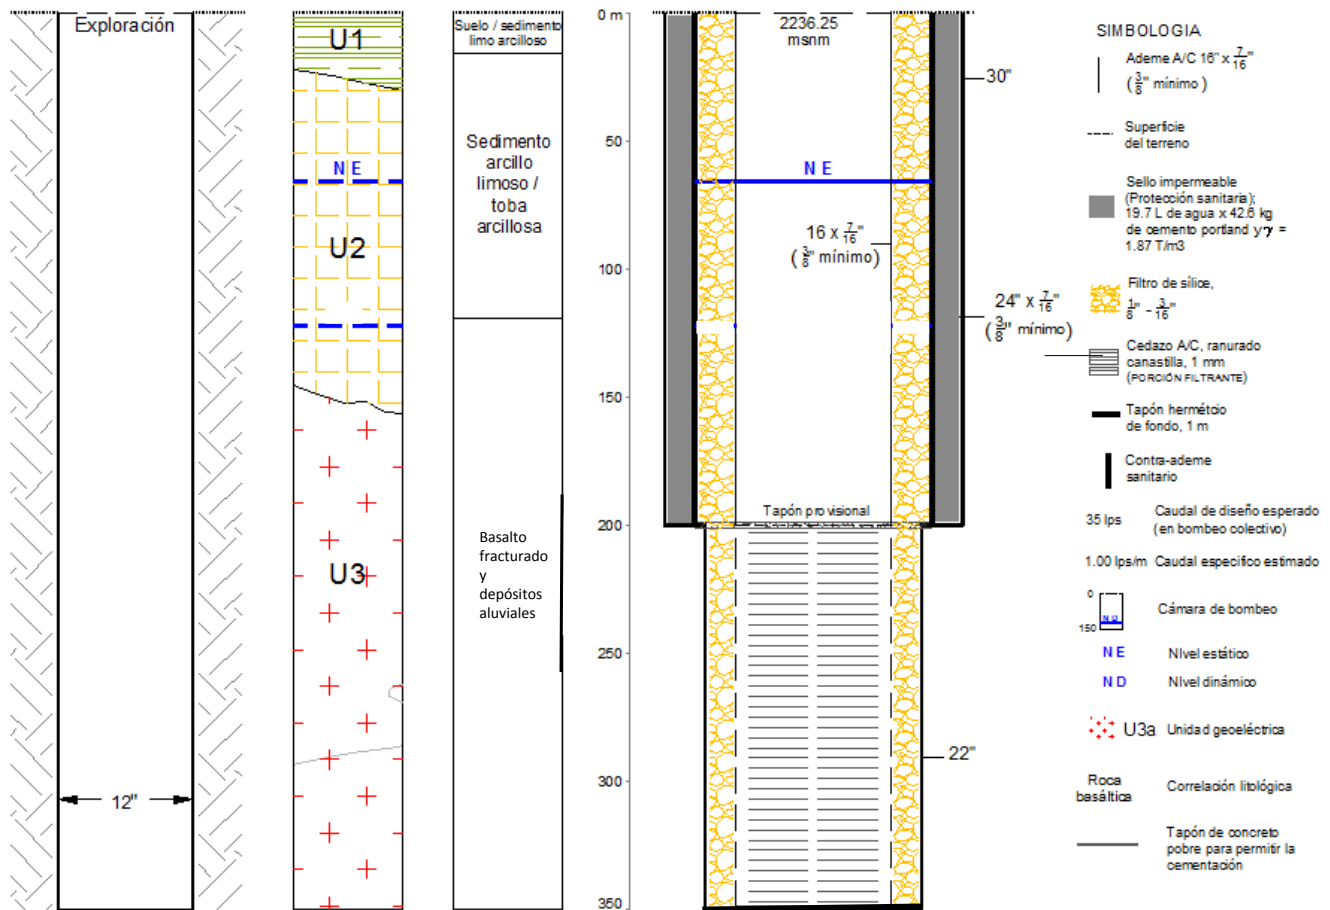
Proyecto de Pozo Tipo 6
